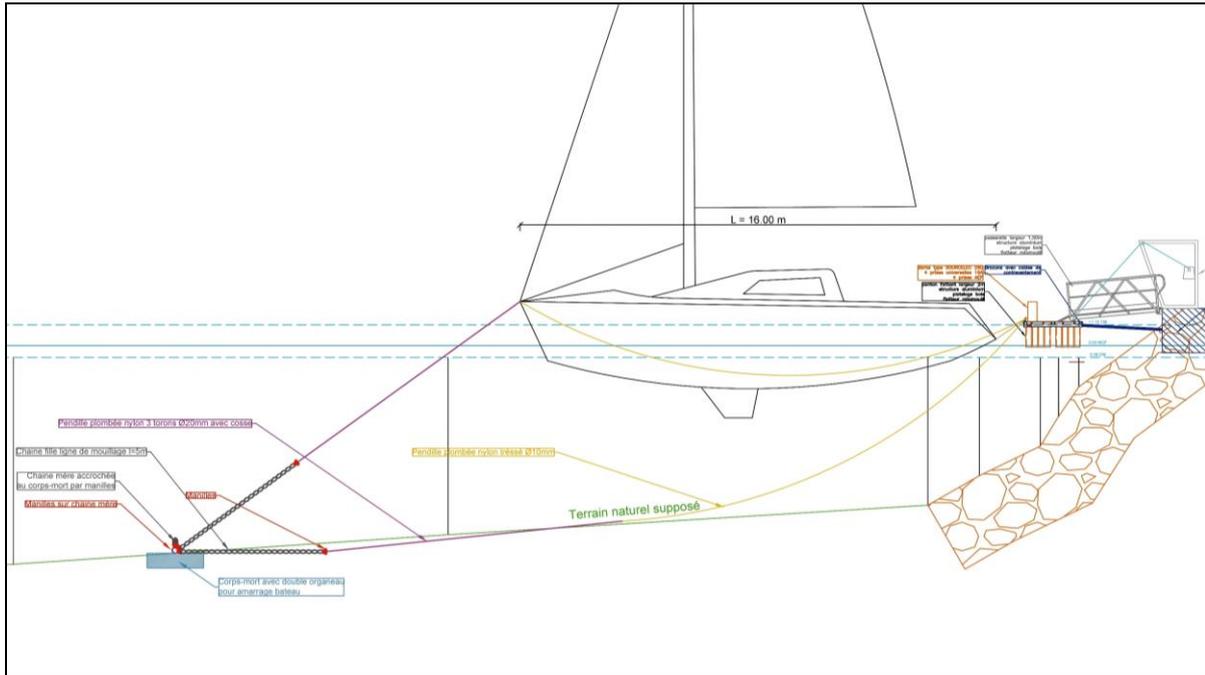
Coupe type du ponton flottant sur bracon avec mouillage
